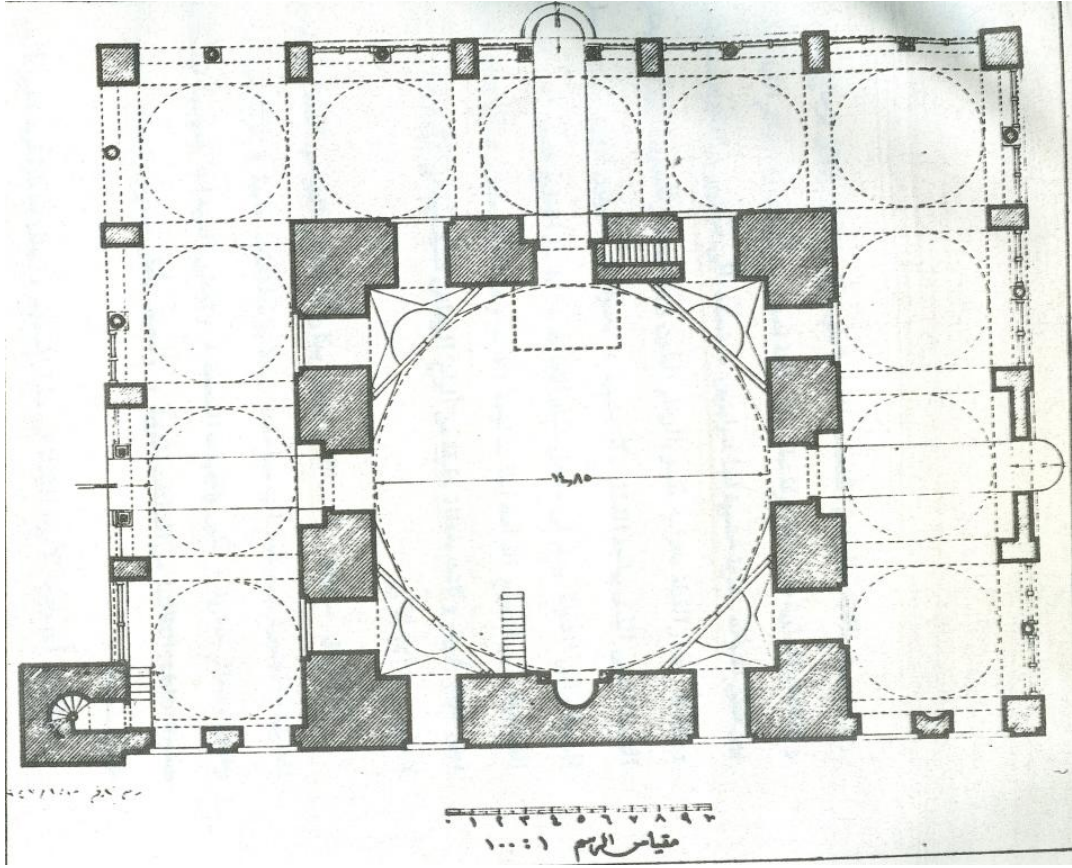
/ب): مسقط أفقي لجامع قجماس الإسحاقى. عن: مركز تسجيل الآثار
